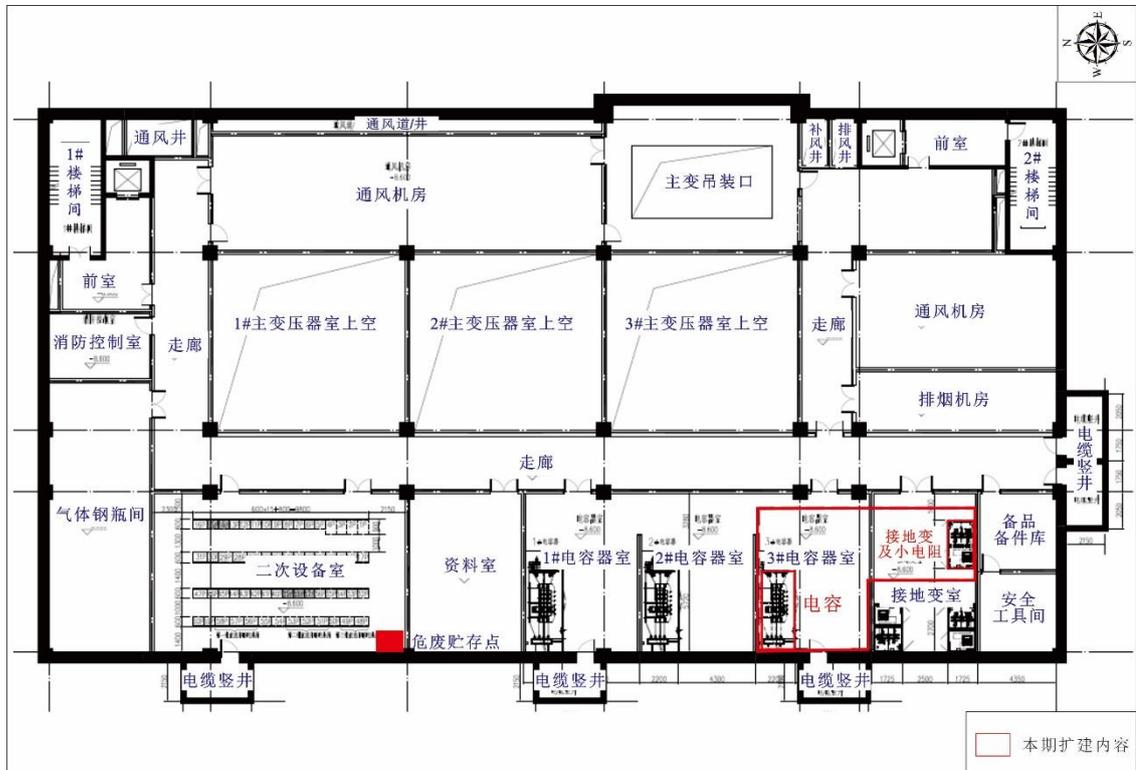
西安昌明 110kV 变电站地下二层平面布置图
